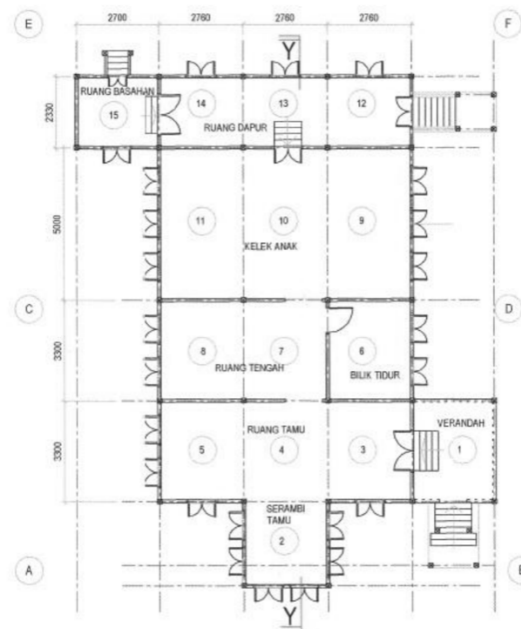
Floor plan Rumah Tok Su (Source: *Wahab & Ismail, 2014*)
